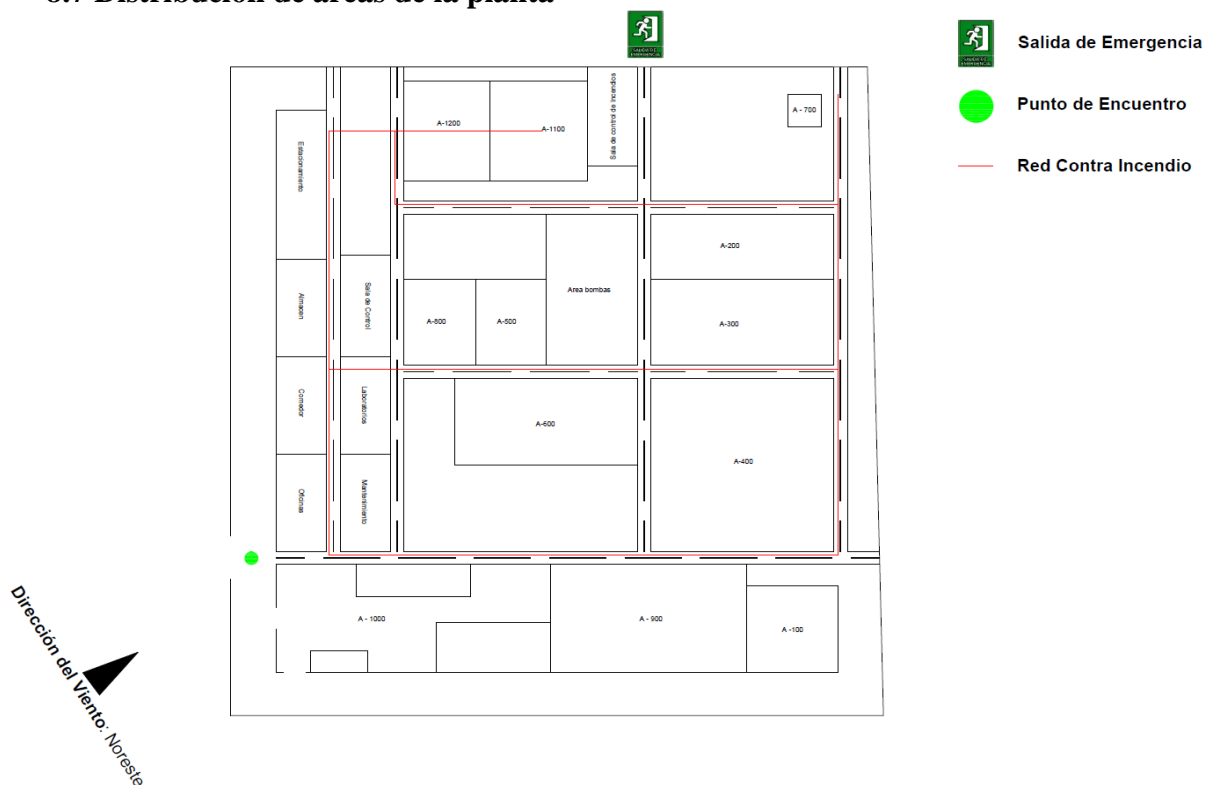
LayOut General de la Planta Butadieno (Propia, 2021).
